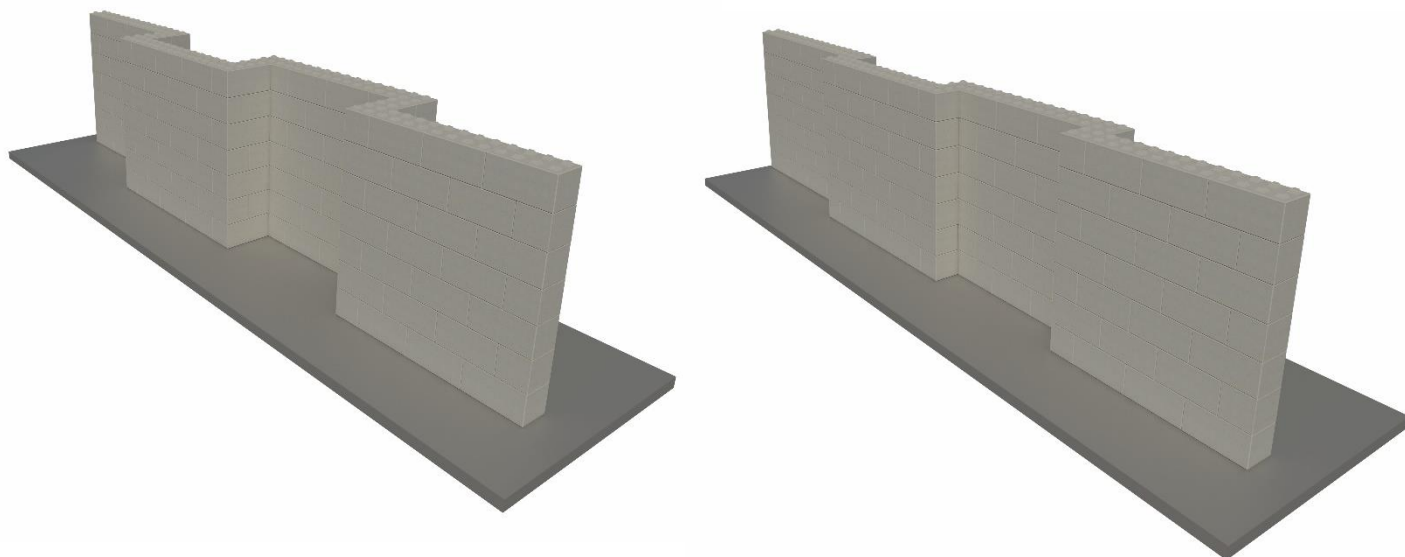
b. Murstabilitet fra grunnens bærestyrke samt blokkens egenvekt som ballast.
